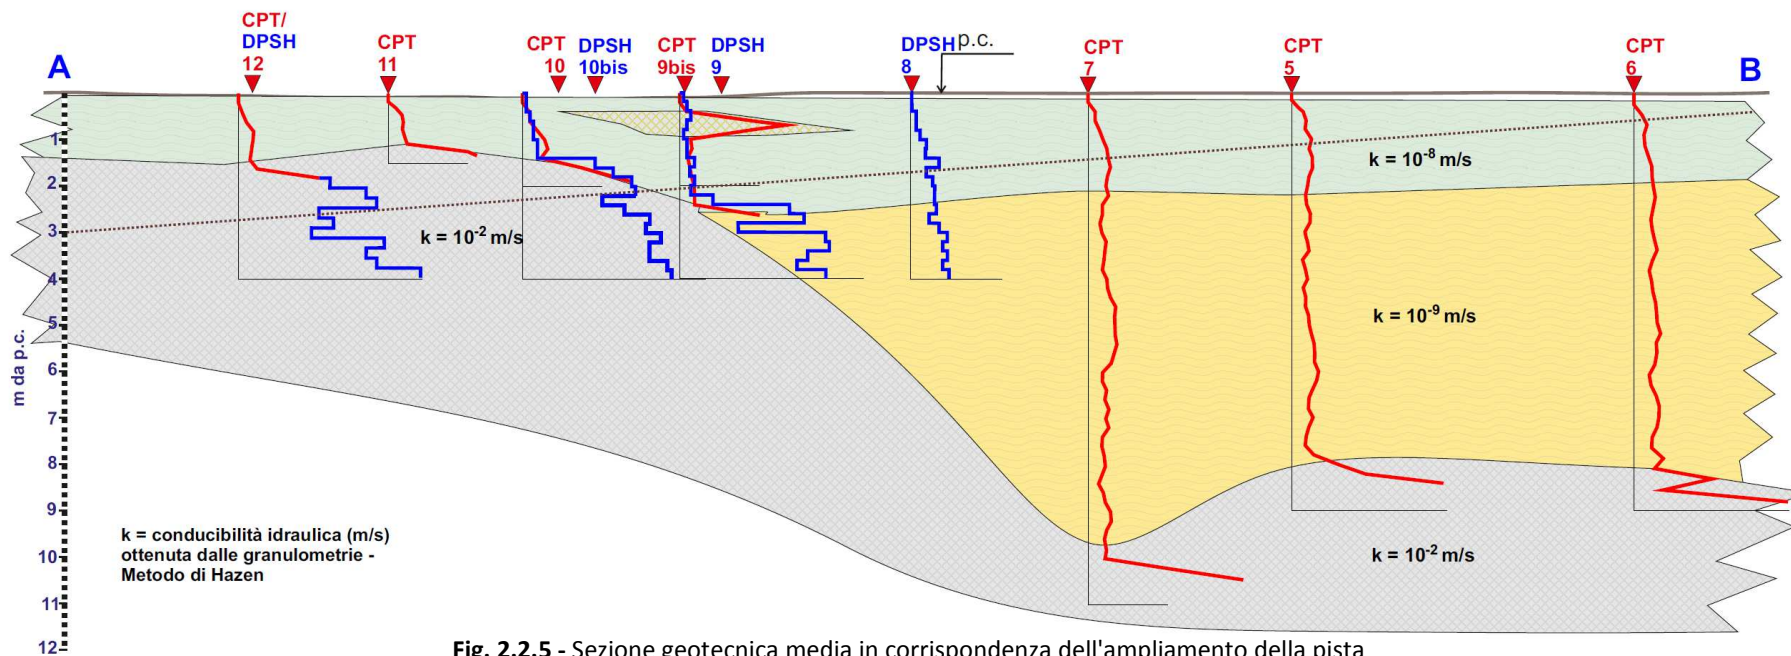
Sezione geotecnica media in corrispondenza dell'ampliamento della pista
